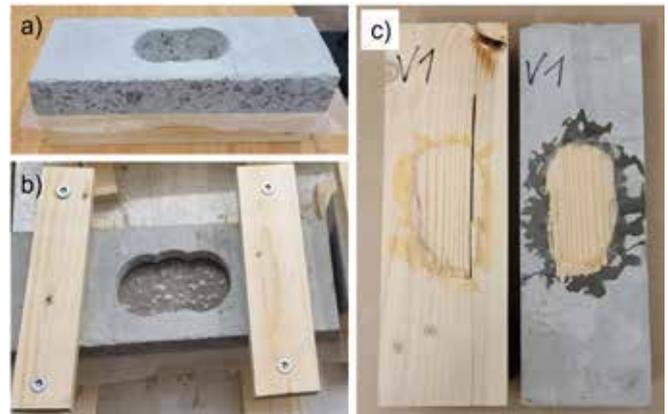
Prüfkörperherstellung in Anlehnung an DIN EN 408 mit der Vergussmethode: a) Positionierung des Betonsubstrats mit drei Kernlochbohrungen und Abdichtfolie auf dem Holzsubstrat, b) Fixierung der Substrate und Auffüllen der Aussparung mit Klebstoff (Aushärten), c) Bruchbild mit Holzausschnitt nach der Prüfung. © Univ. Kassel FBH
